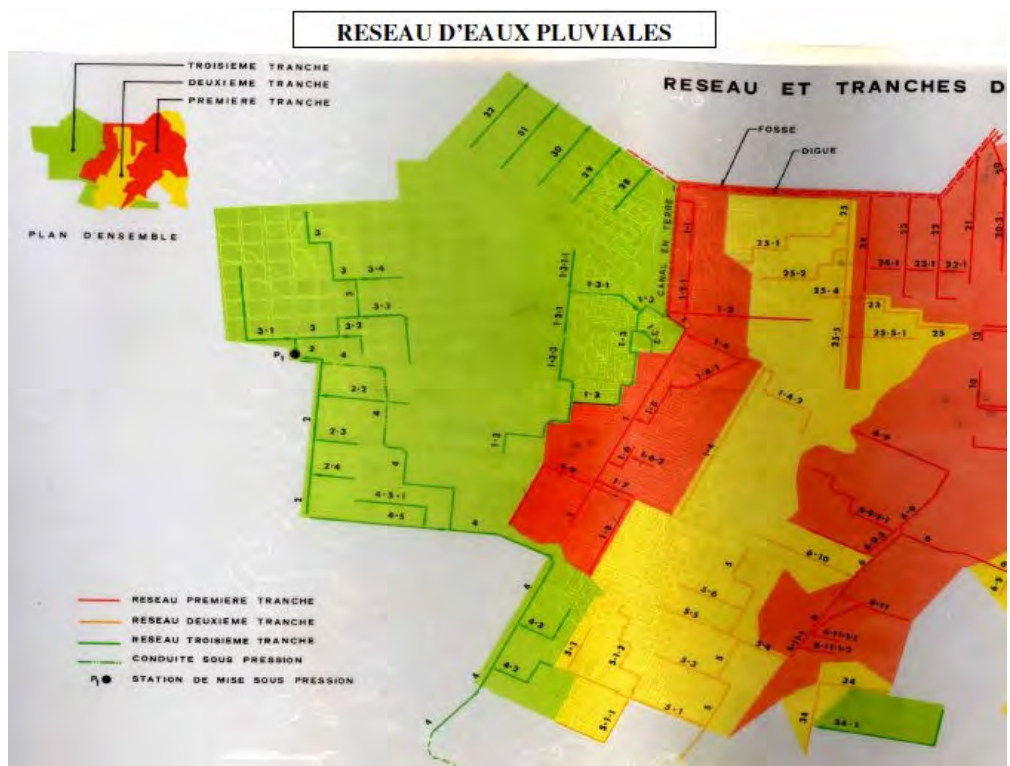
Plan de réseau d'eaux pluviales (Plan cadre d'assainissement de la Ville de Kaolack, 1979)
